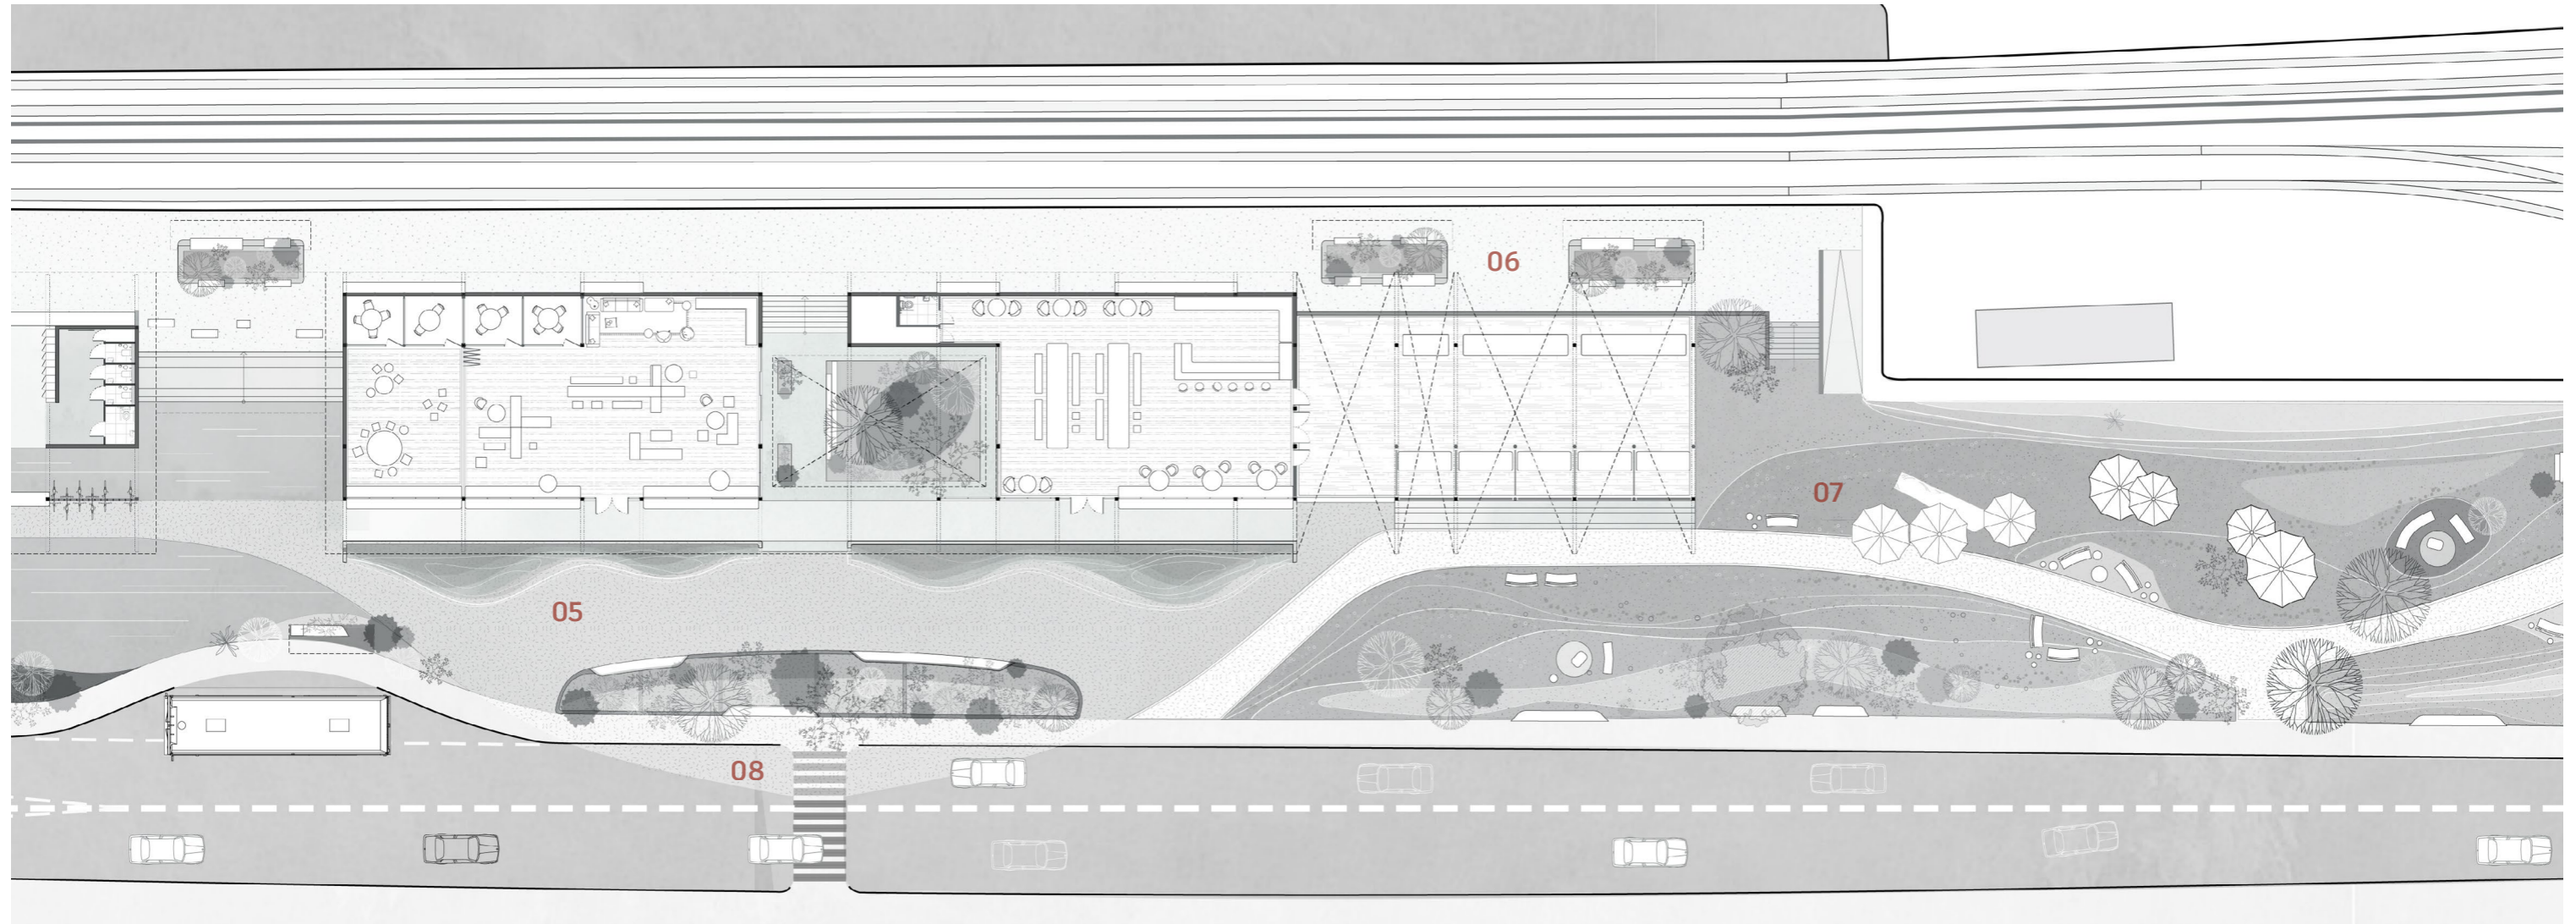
Part Site Plan (2)- Sandareds Hjärta
